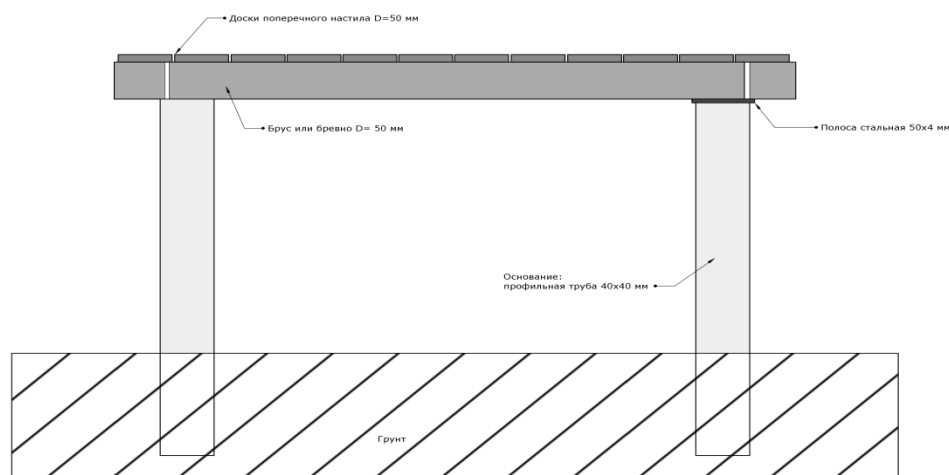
Рабочий эскиз конструкции настила из дерева
